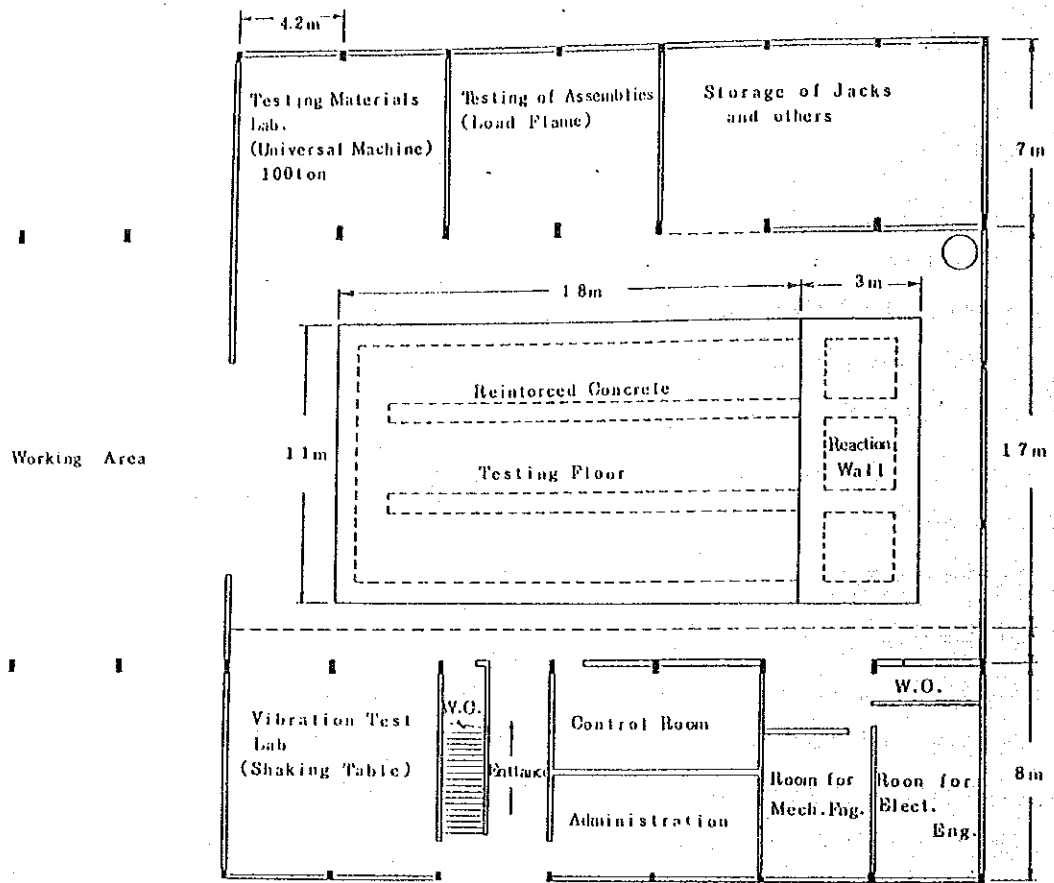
STRUCTURAL TESTING LAB: 1<sup>st</sup> STORY 1/200
